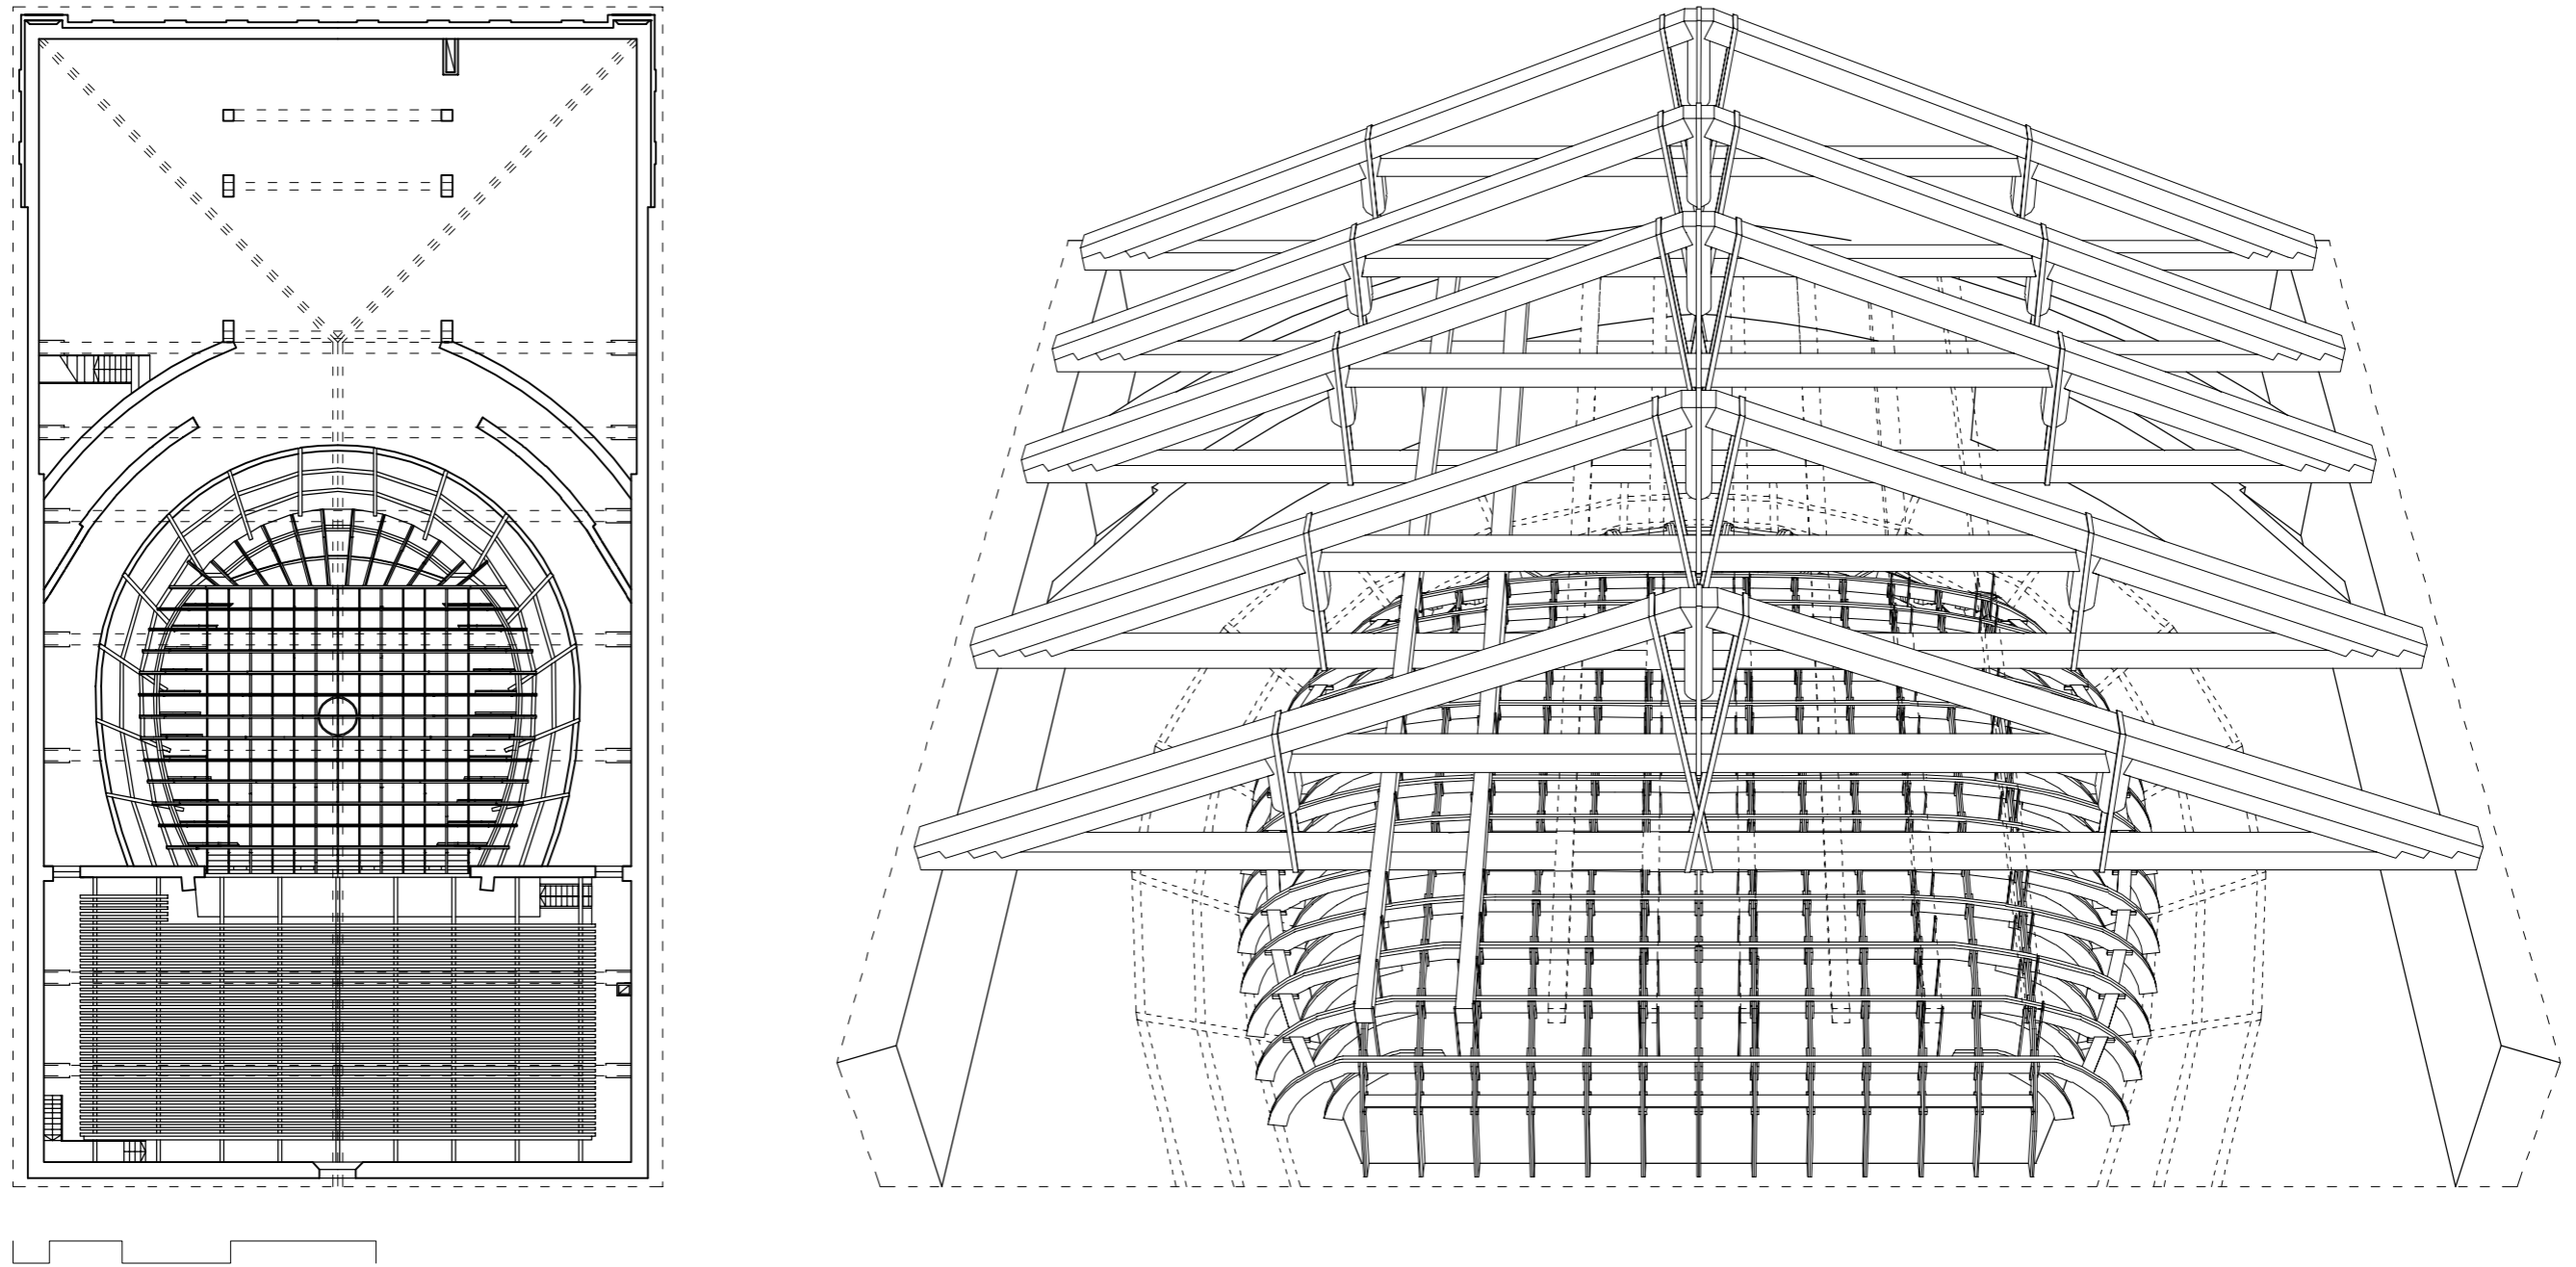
Teatro Comunale di Crevalcore. Pianta del piano sottotetto (ridisegno); rappresentazione prospettica del sistema di copertura della sala.
